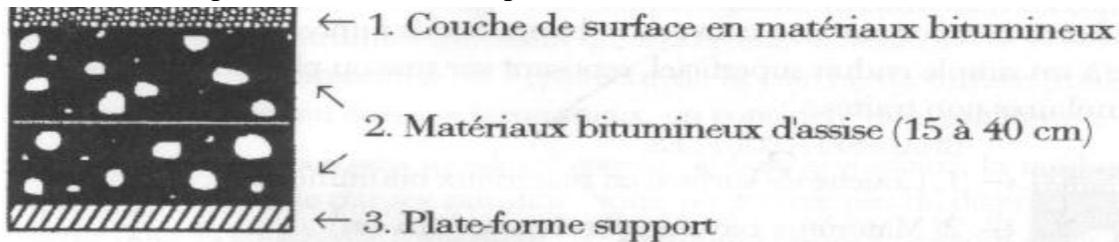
Chaussée bitumineuse épaisse [catalogue des chaussées, 1998]
